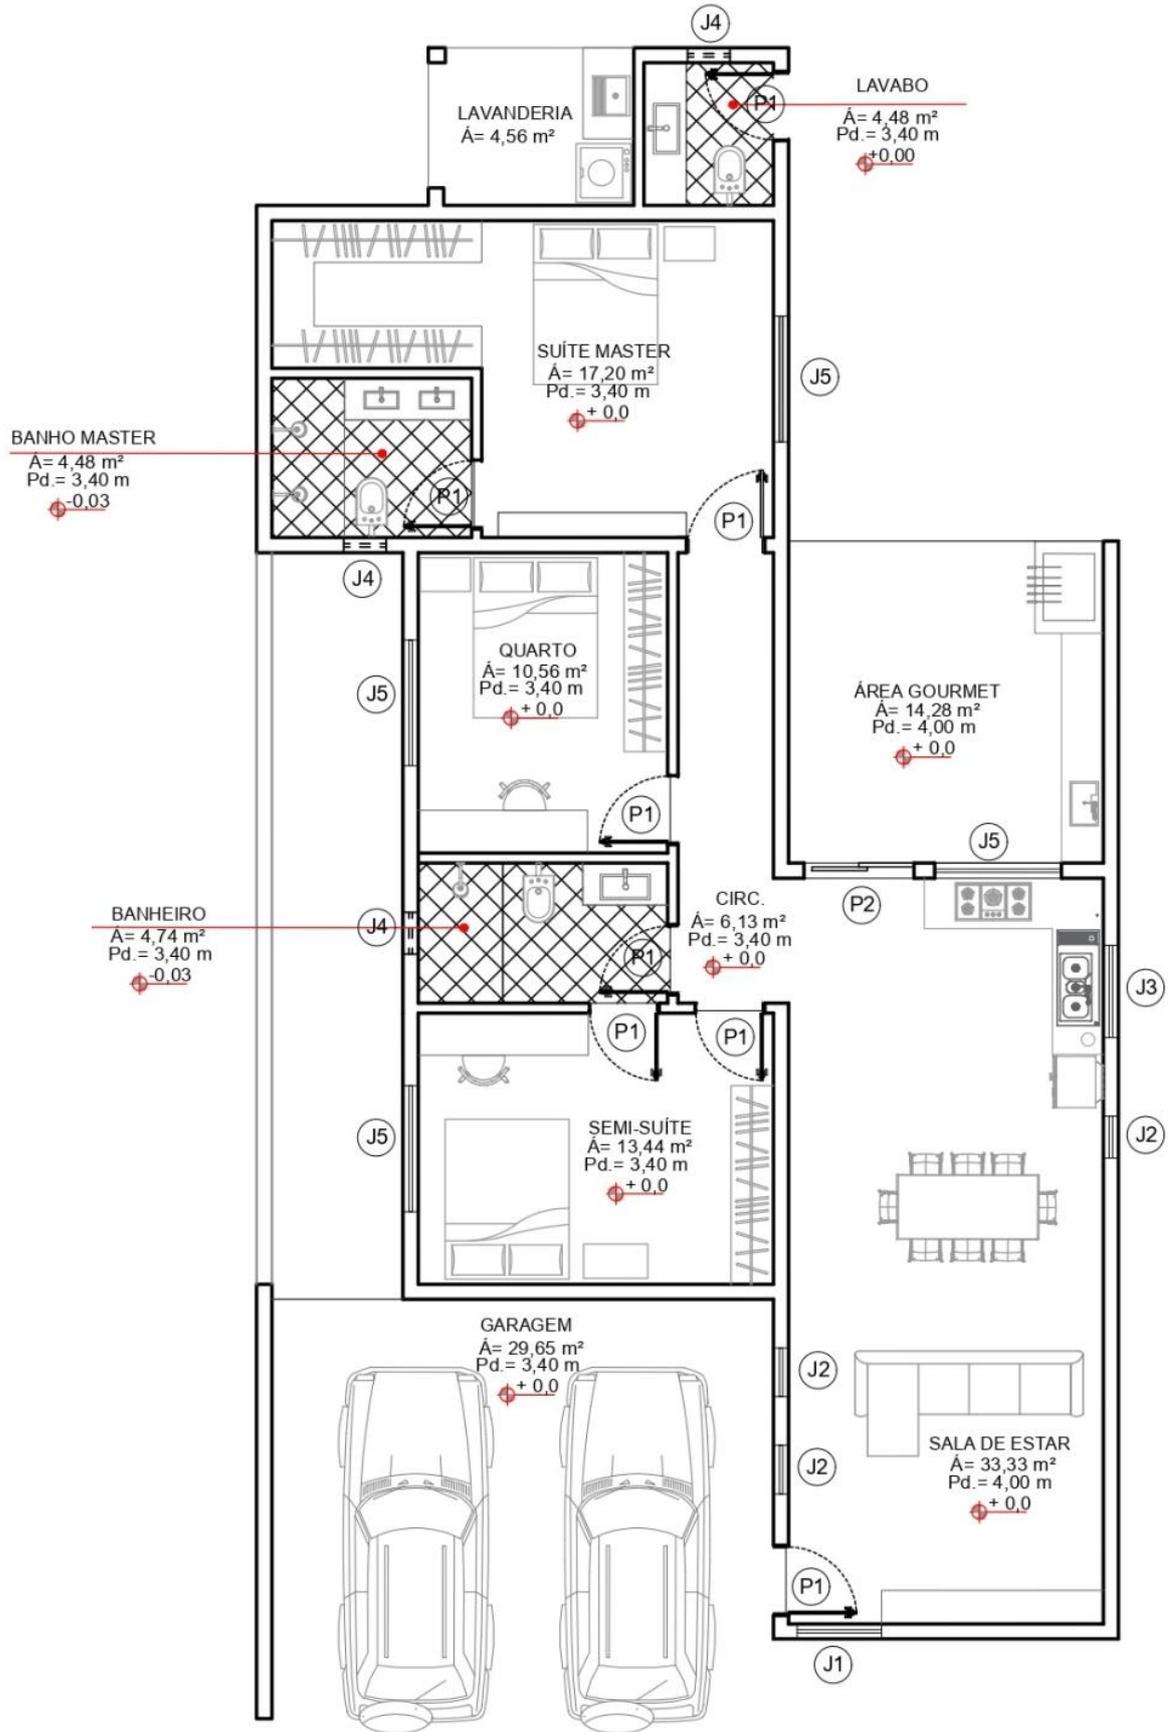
Planta Baixa. (ICF CONSTRUTORA, 2023)
